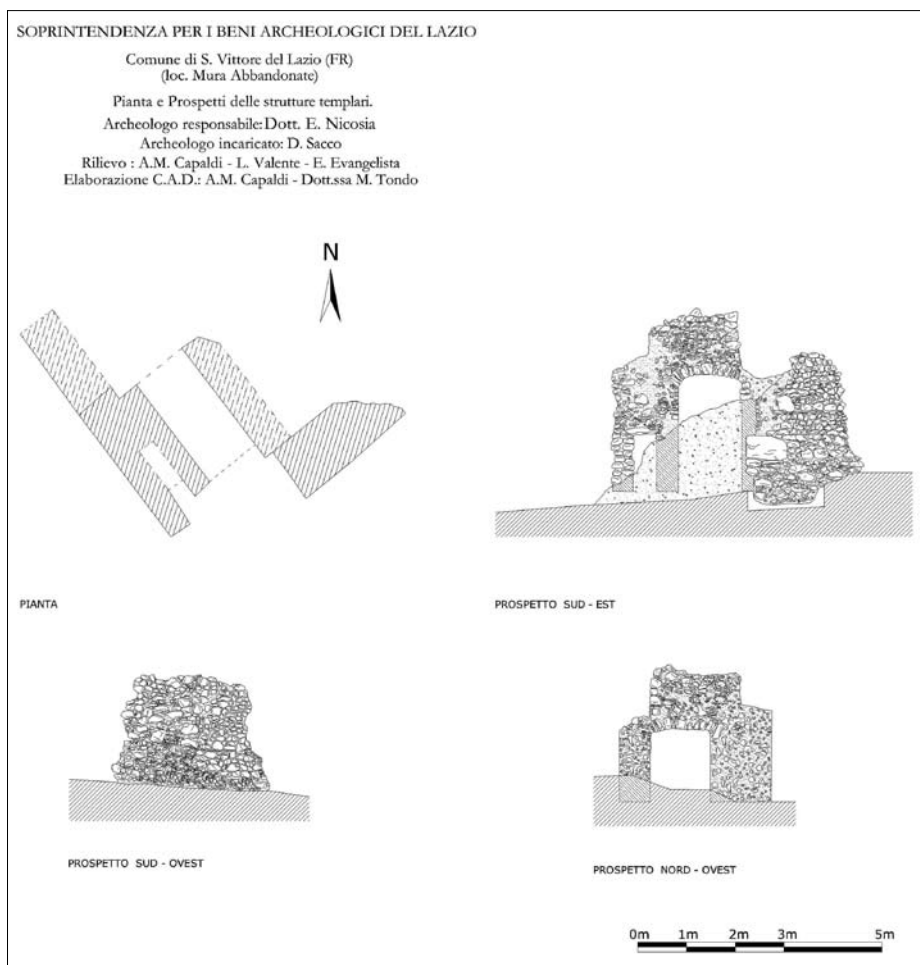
Strutture in opera incerta: pianta e sezioni.
